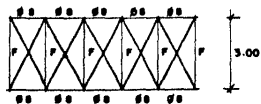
a) ALZADOS ARMADO TRIDILOSA PUENTE CRUCE CARRETERA SANALONA-TOPIA-RIO TANAZULA II.
